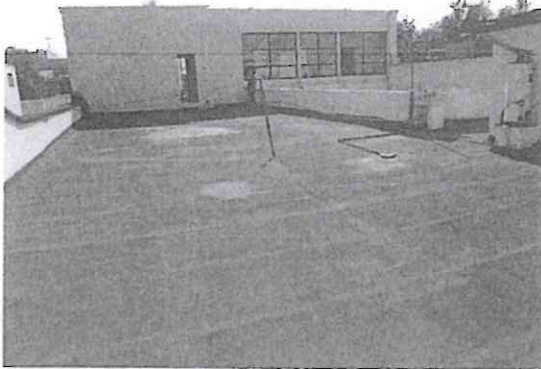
Losa plana de azotea, sin afectaciones estructurales.
